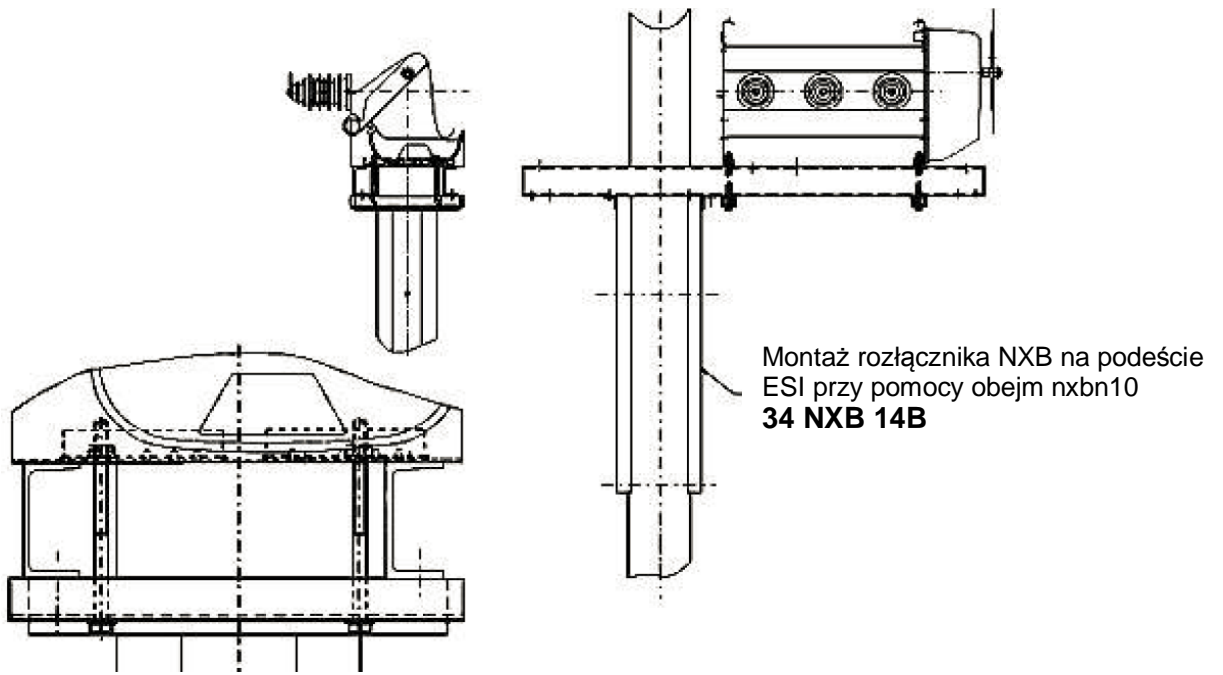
Montaż NXB na 1 słupie okrągłym betonowym, poniżej poprzeczki, działanie silnikowe
